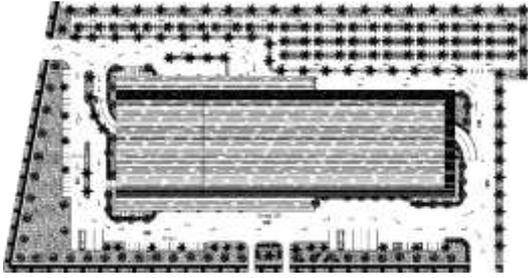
Sirkulasi Ruang Dalam Lantai 1
